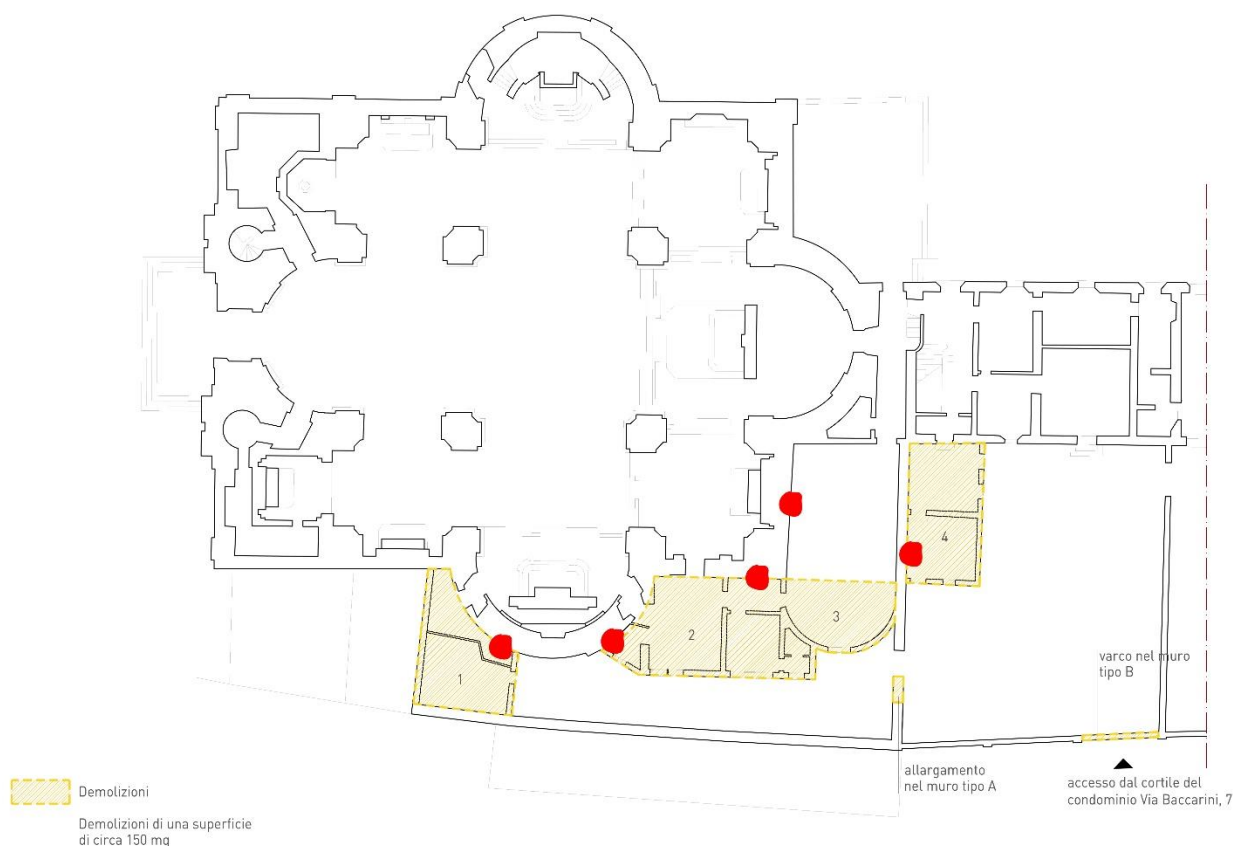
Planimetria della chiesa con indicazione dei sondaggi fondali eseguiti (punti rossi) e degli annessi demoliti (in giallo)
